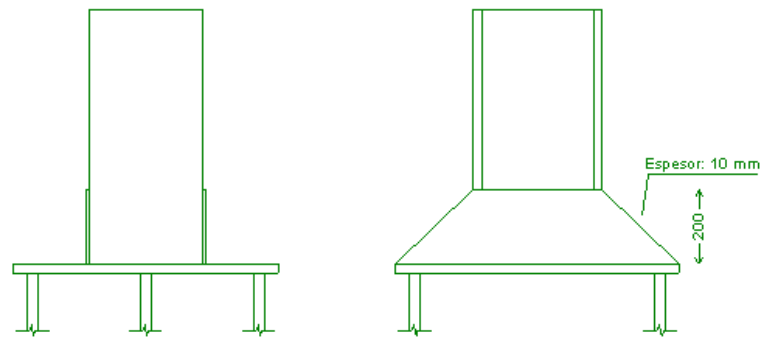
Alzado y perfil de la placa de anclaje.
